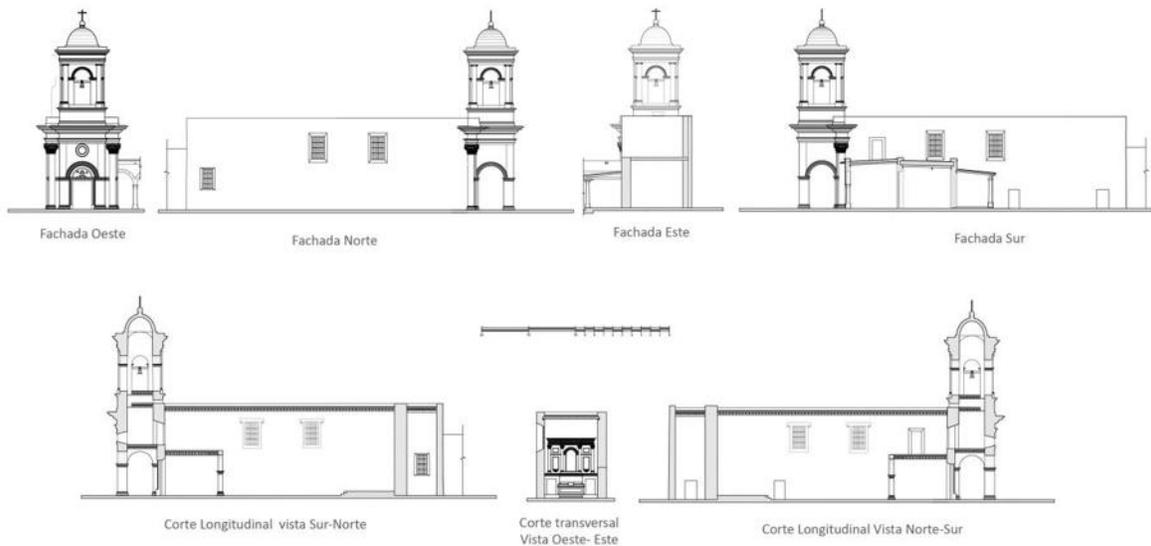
Capilla en el momento de su reconstrucción, cortes y fachadas - elaborado por el autor
